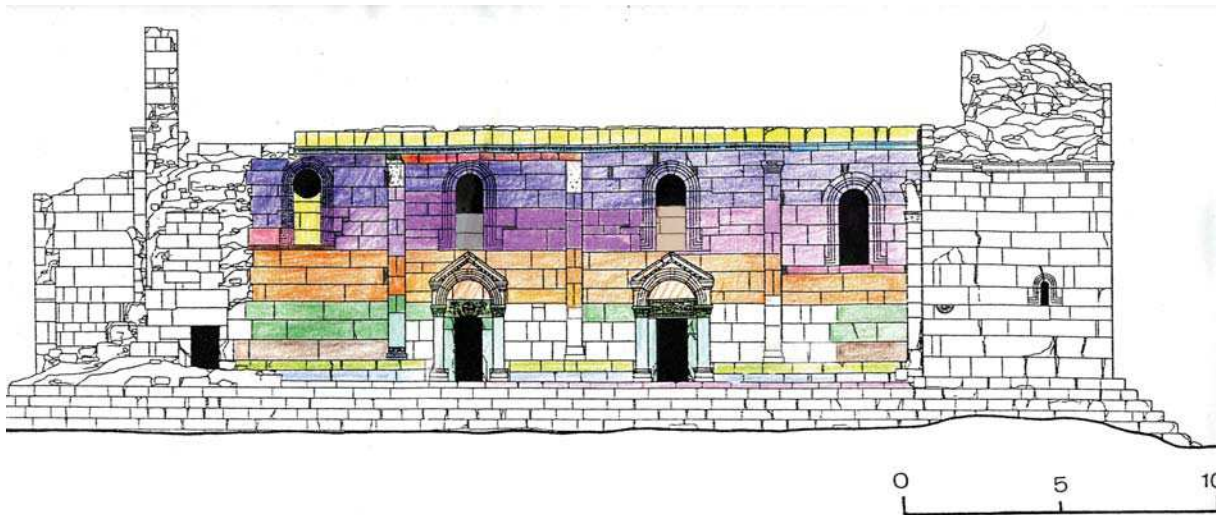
Ereruyk. Basilique, façade sud. Phasage constructif.
